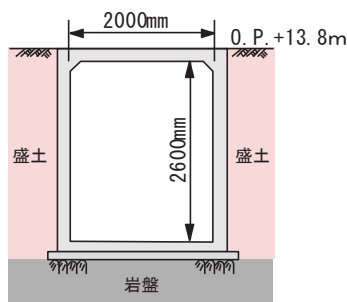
に北側排水路及び南側排水路の断面図を、表6.5.1.8-1に各排水路の排水能力を示す。
